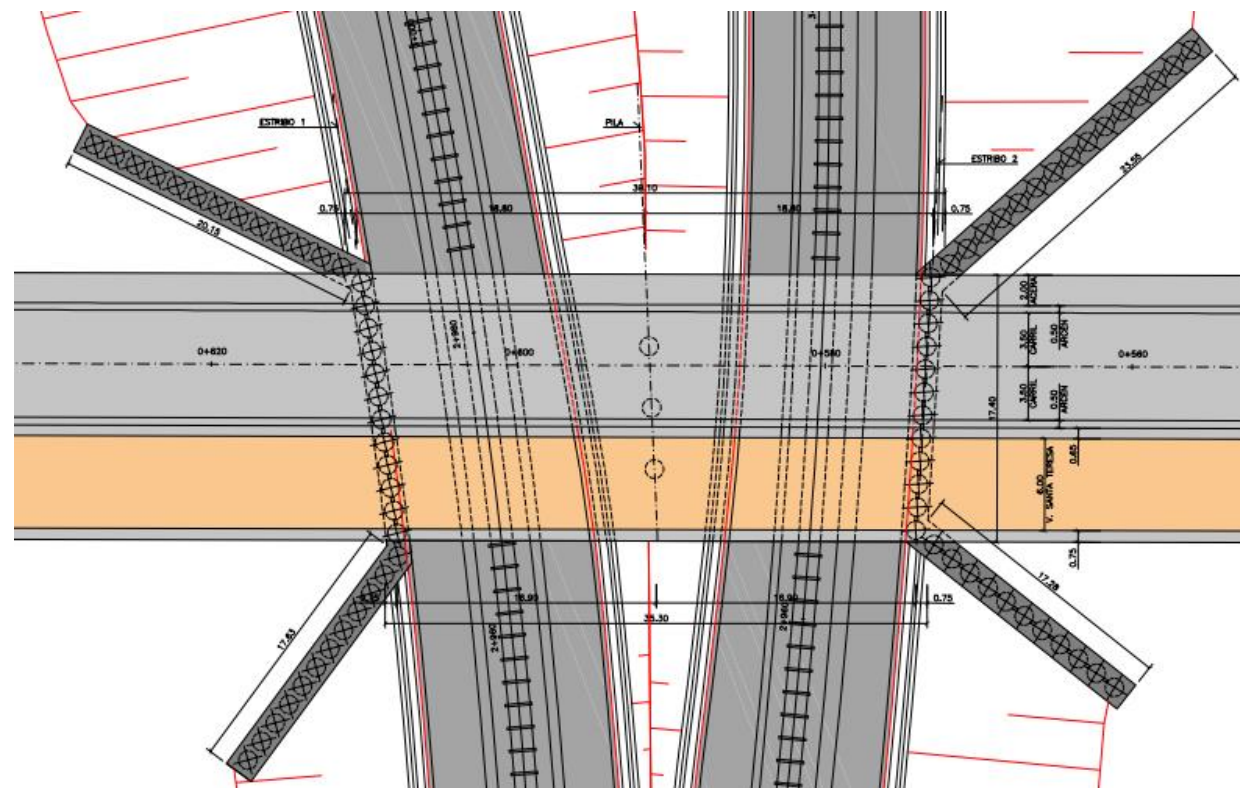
PLANTA PS ACCESO ESTACIÓN DE ELCHE Y COLADA DE SANTA TERESA P.K. 2+990
